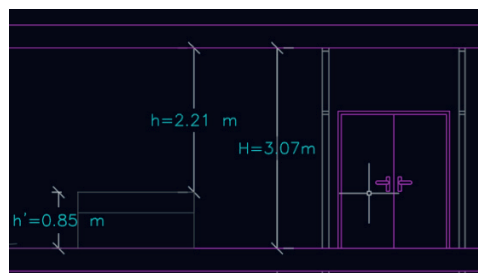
Dimensiones local (Imagen Autocad planos proyecto)
